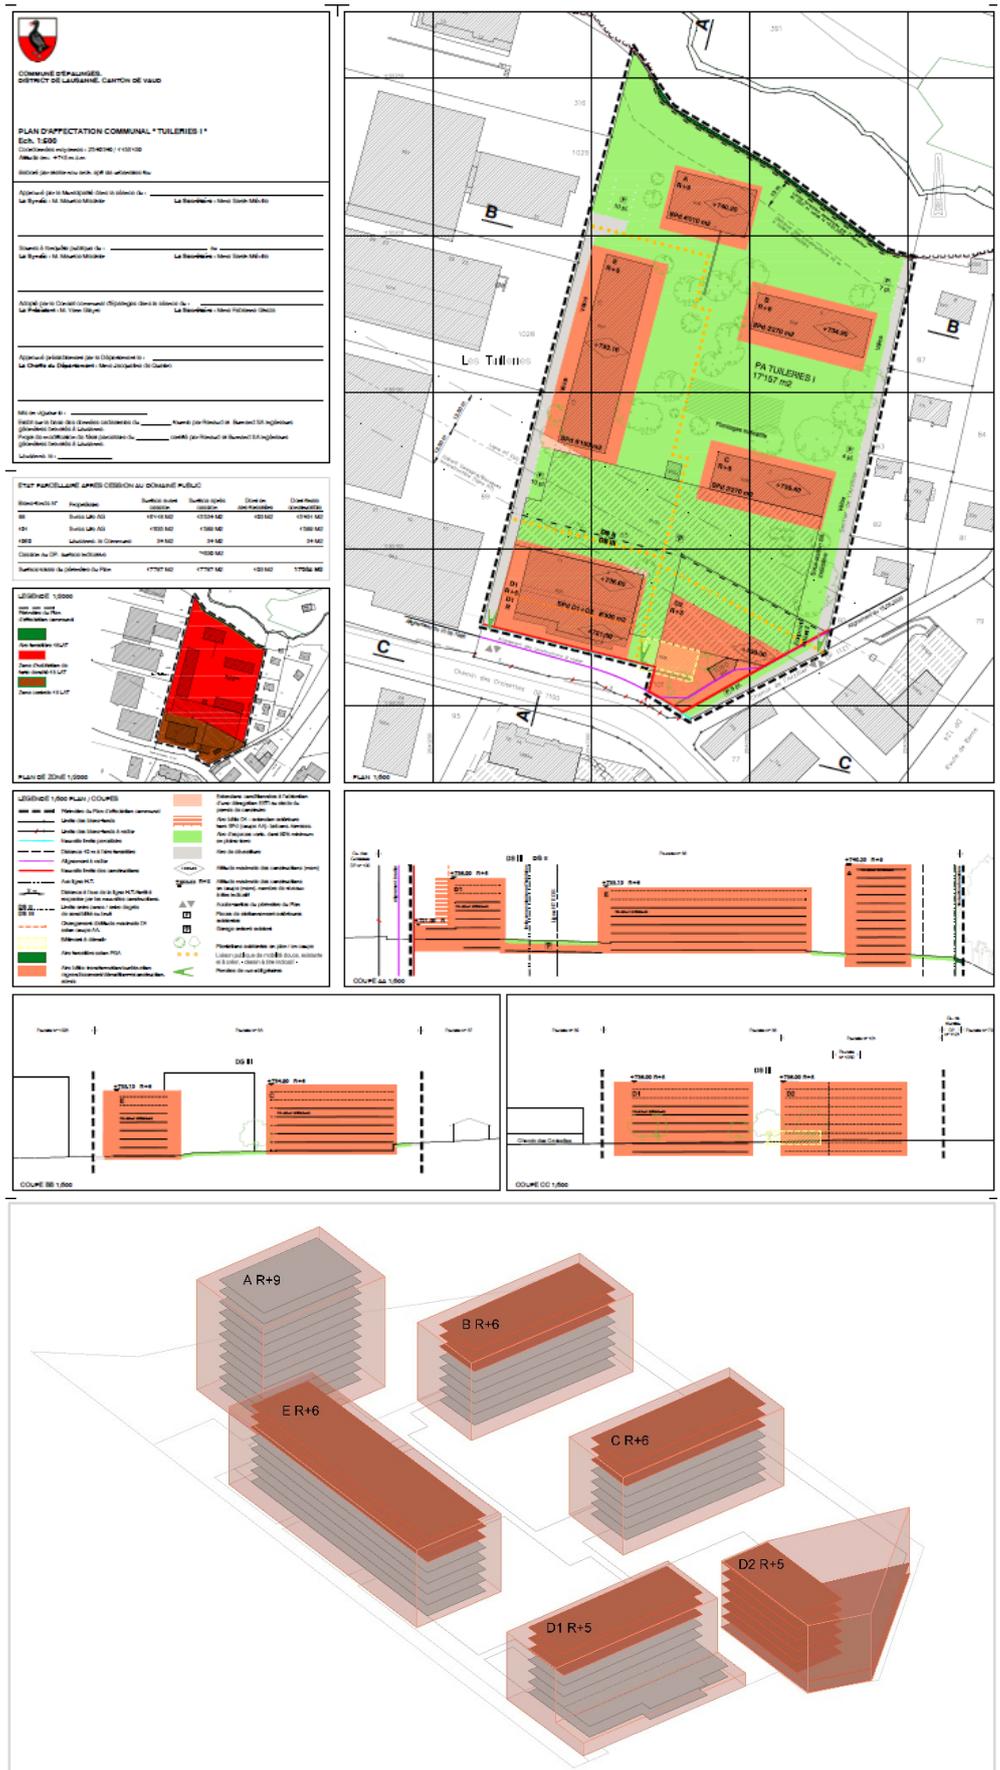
et 17 – En haut, PA « Tuileries I », plan et coupes réduites ©atelier nou
